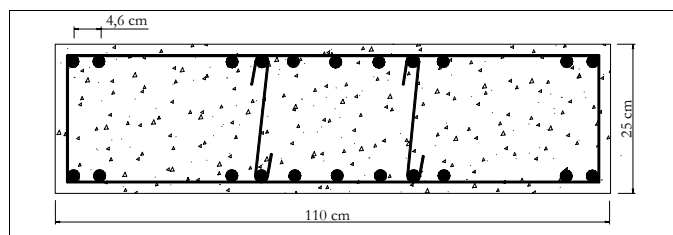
Caso 4: Arranjo das armaduras na seção transversal do pilar P1.
